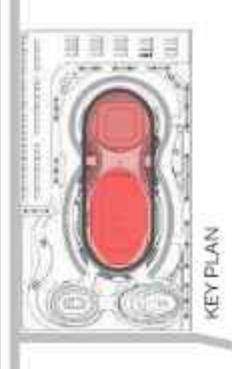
( GEDUNG LATIHAN )
